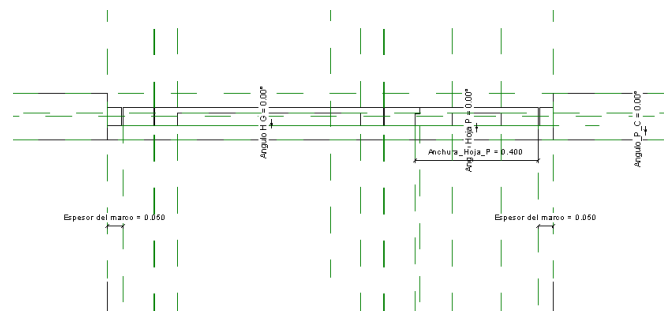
Vista de plano de planta de la familia puerta. Fuente: Elaboración propia.
